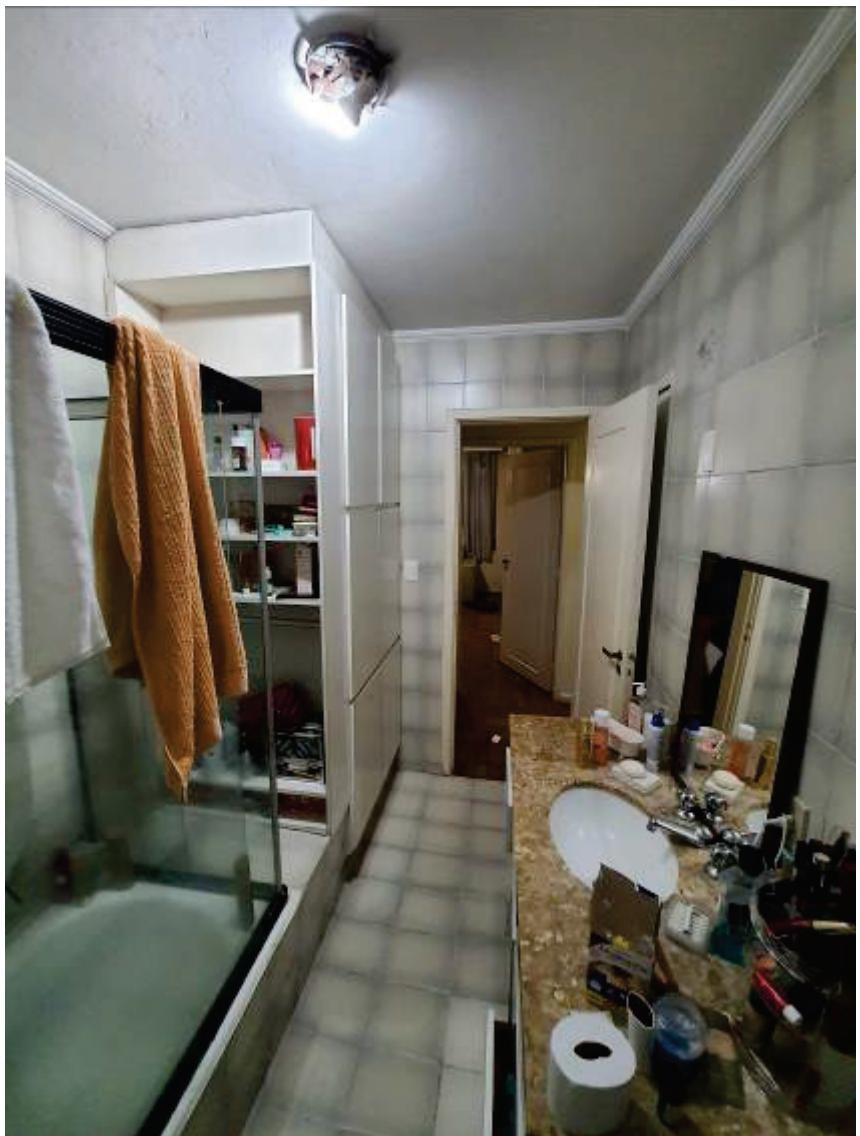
OUTRA VISTA DO BANHEIRO SOCIAL.
